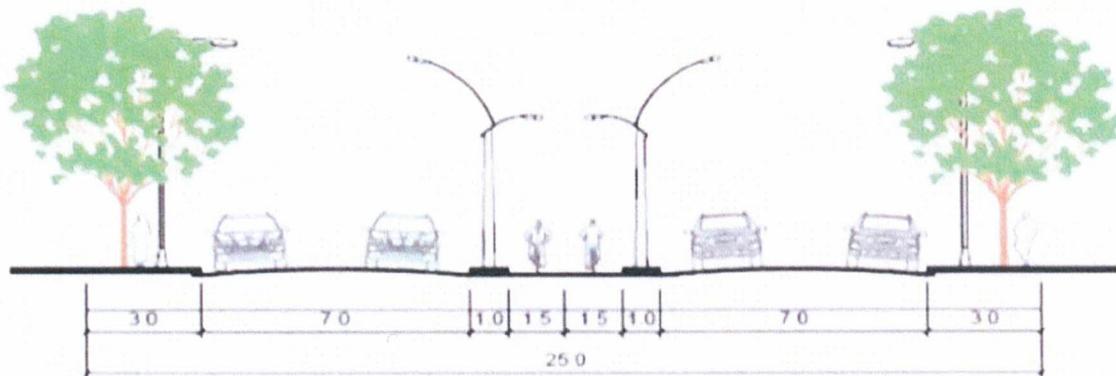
Detalhe do arruamento da duplicação da via coletora Rua Luiz Izzo a ser implantado no acesso ao loteamento.
